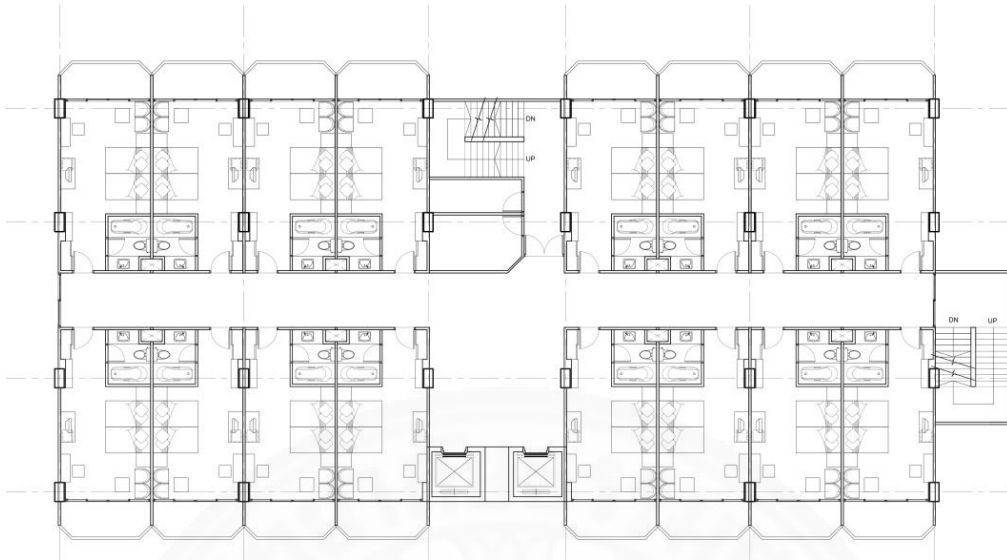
แสดงผังชั้นที่ 1 โครงการ B
